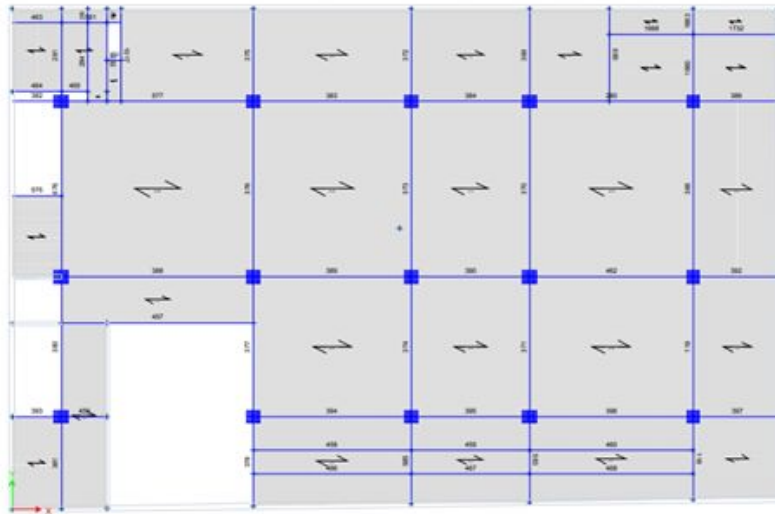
Planta de la estructura mostrando la numeración y ubicación de las barras que conforman las trabes en un nivel.
